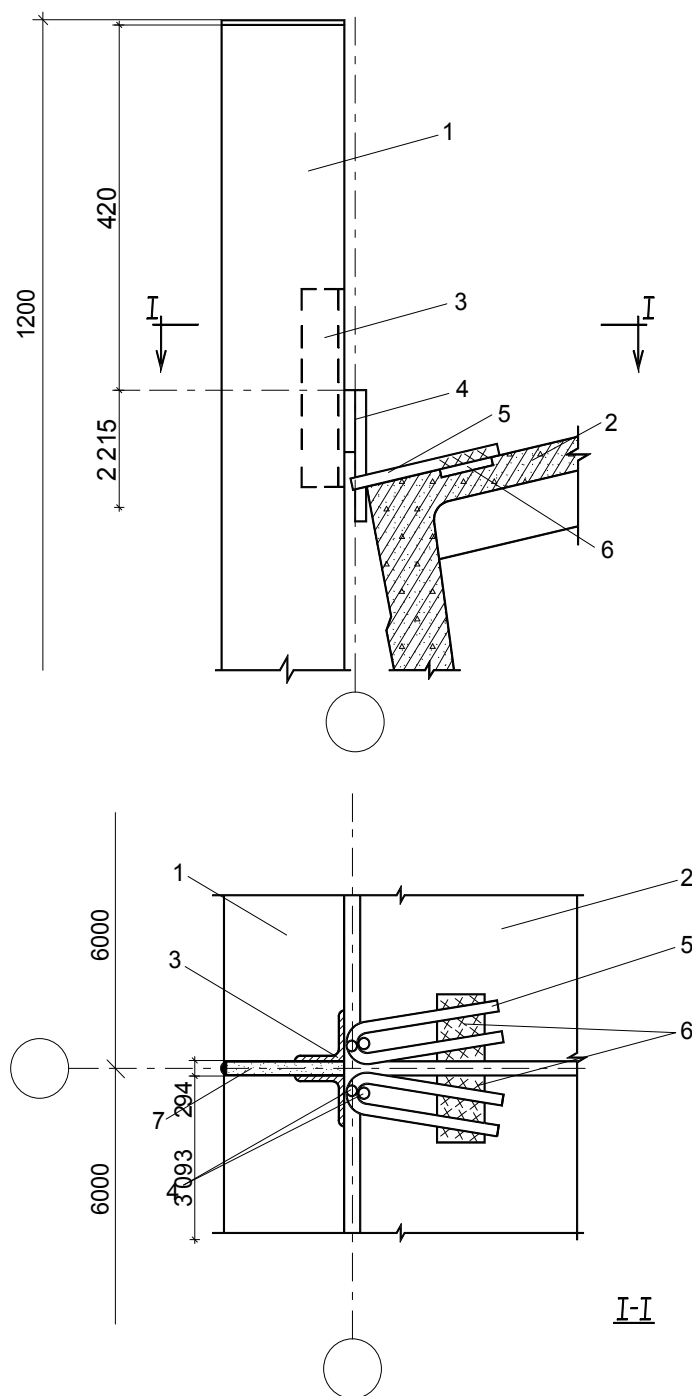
Кріплення парапетних панелей поздовжньої стіни до плит покриття в крановому прогоні біля рядової осі: 1 – парапетна модель; 2 – плита покриття; 3 – закладний елемент панелі; 4 – круглі стержні; 5 – петля з круглого стержня; 6 – закладний елемент плити покриття; 7 – цементний розчин
